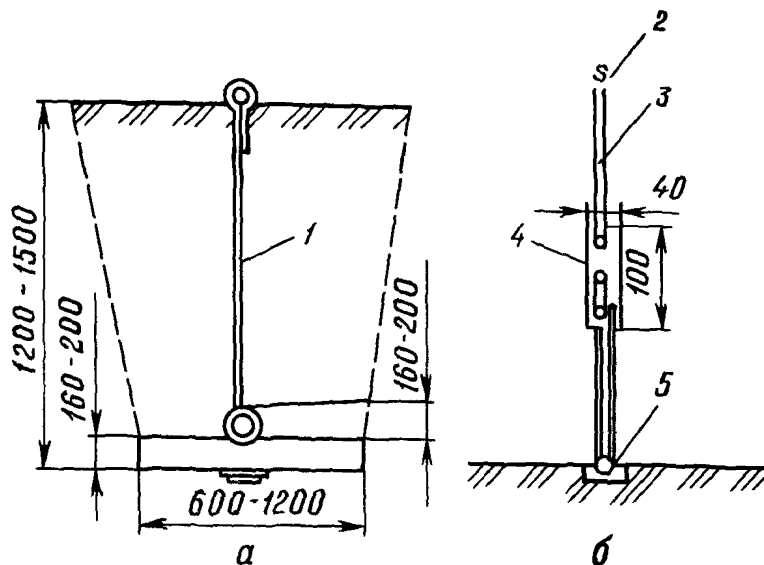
Конструкция якорного крепления анкерного типа:
